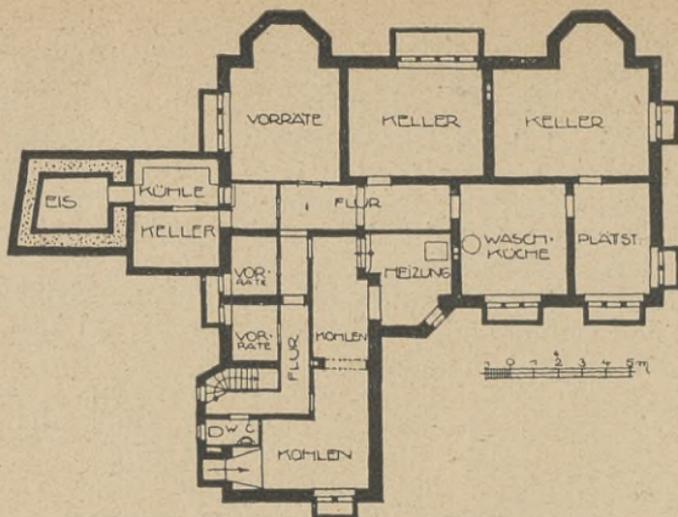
Kellergeschoß mit anschließendem Kühlkeller und Eishaus außerhalb des Hausgrundrisses
